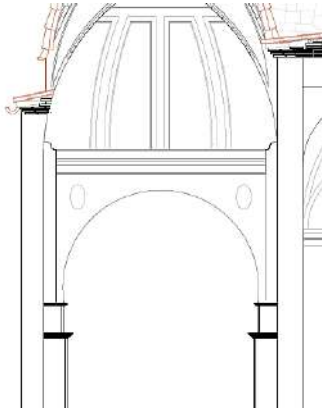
Detalle de los muros de la capilla de la comunión en sección transversal. Imagen propia 20/08/17
